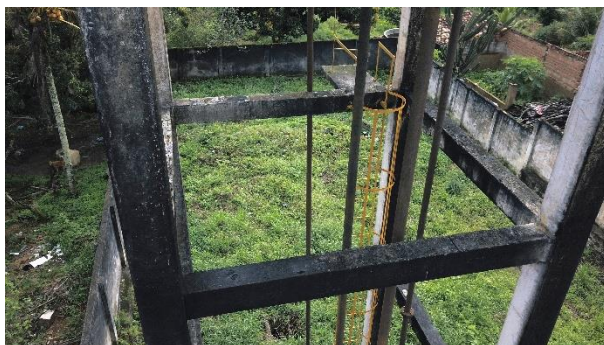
Vista geral superior do estado em que se encontram os pilares e as vigas do reservatório
